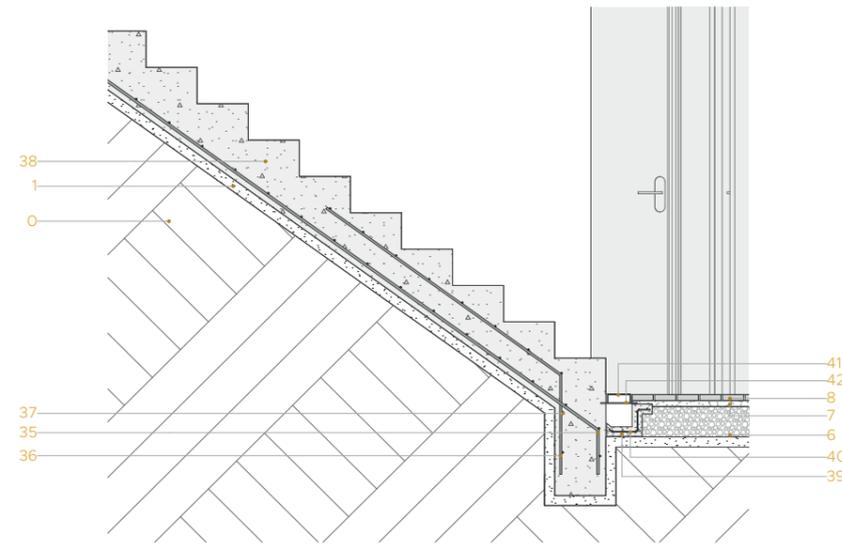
\_C4: sección constructiva\_04, gradas exteriores área construcción y tanatopraxia
